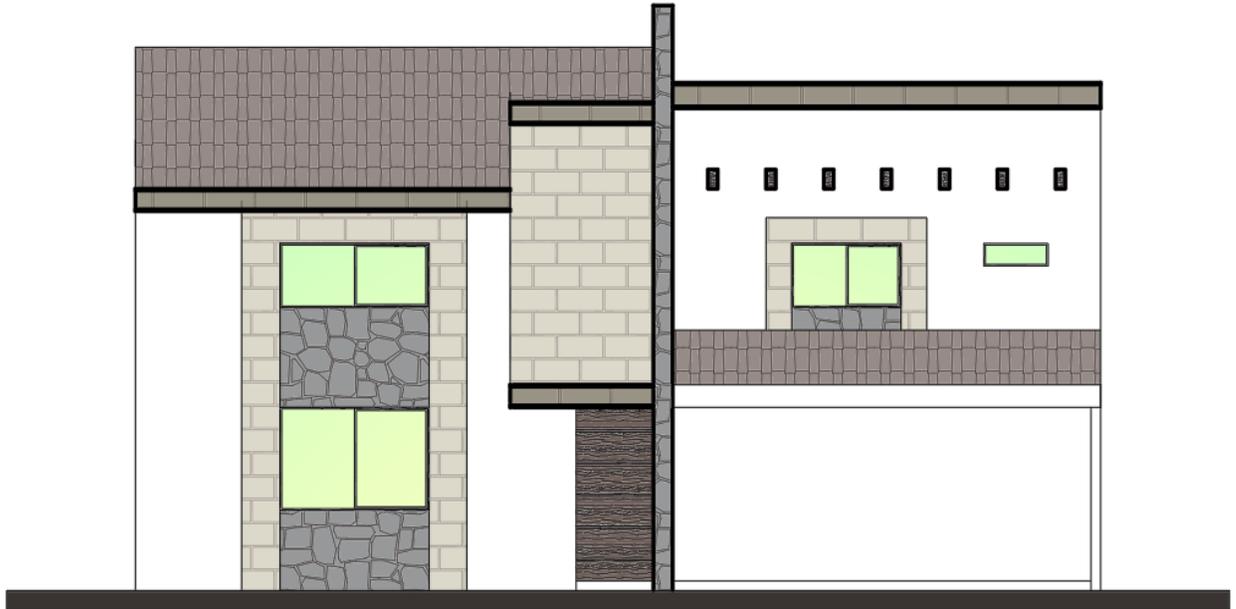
Fachada Frontal "mi casa ecológica" (Muciño, 2022)
